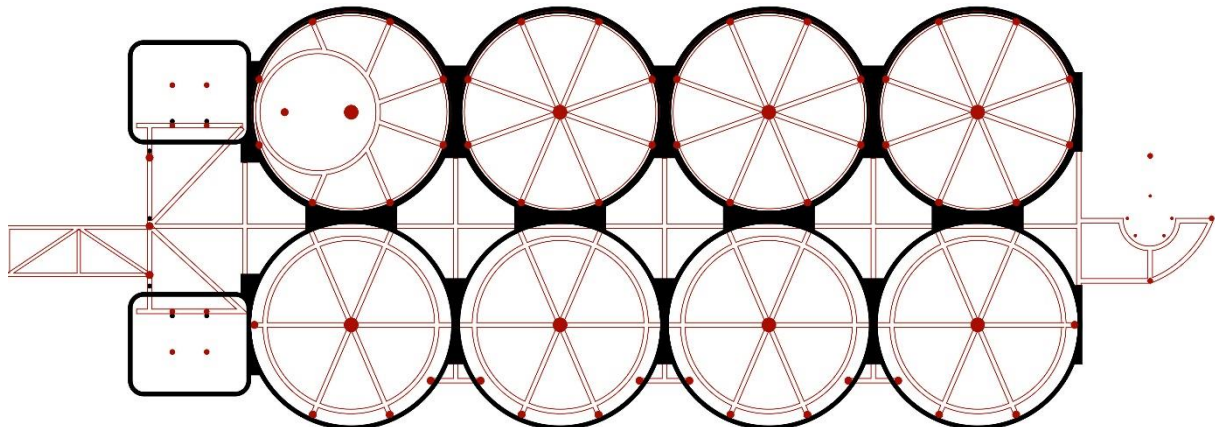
Plan der Neue Skelet Trägerkonstruktion (rot) mit bestehende wänden.
